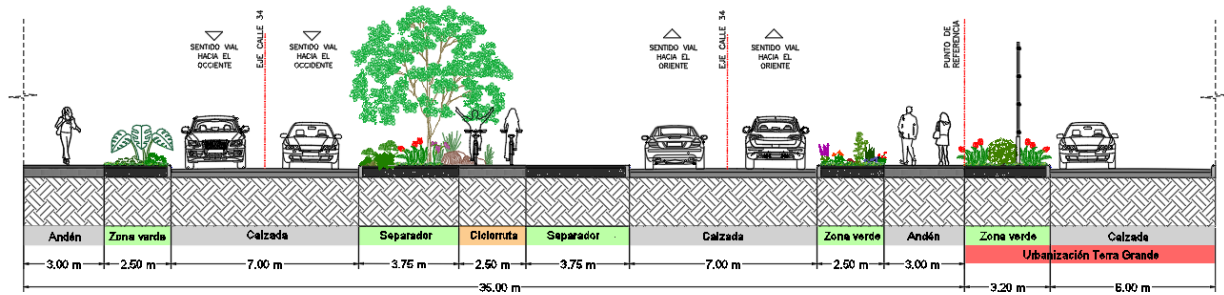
Sección vial uno (1) propuesta transversal 2 y Villas de Gualanday II.
